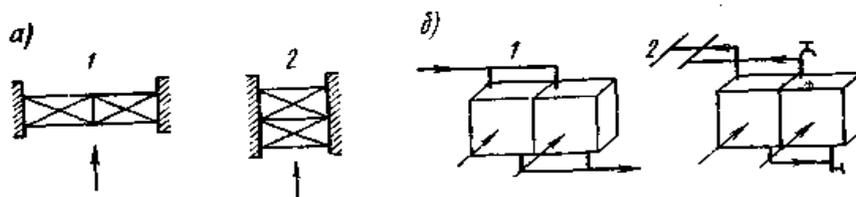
Схемы установки калориферов и присоединения теплопроводов к ним
